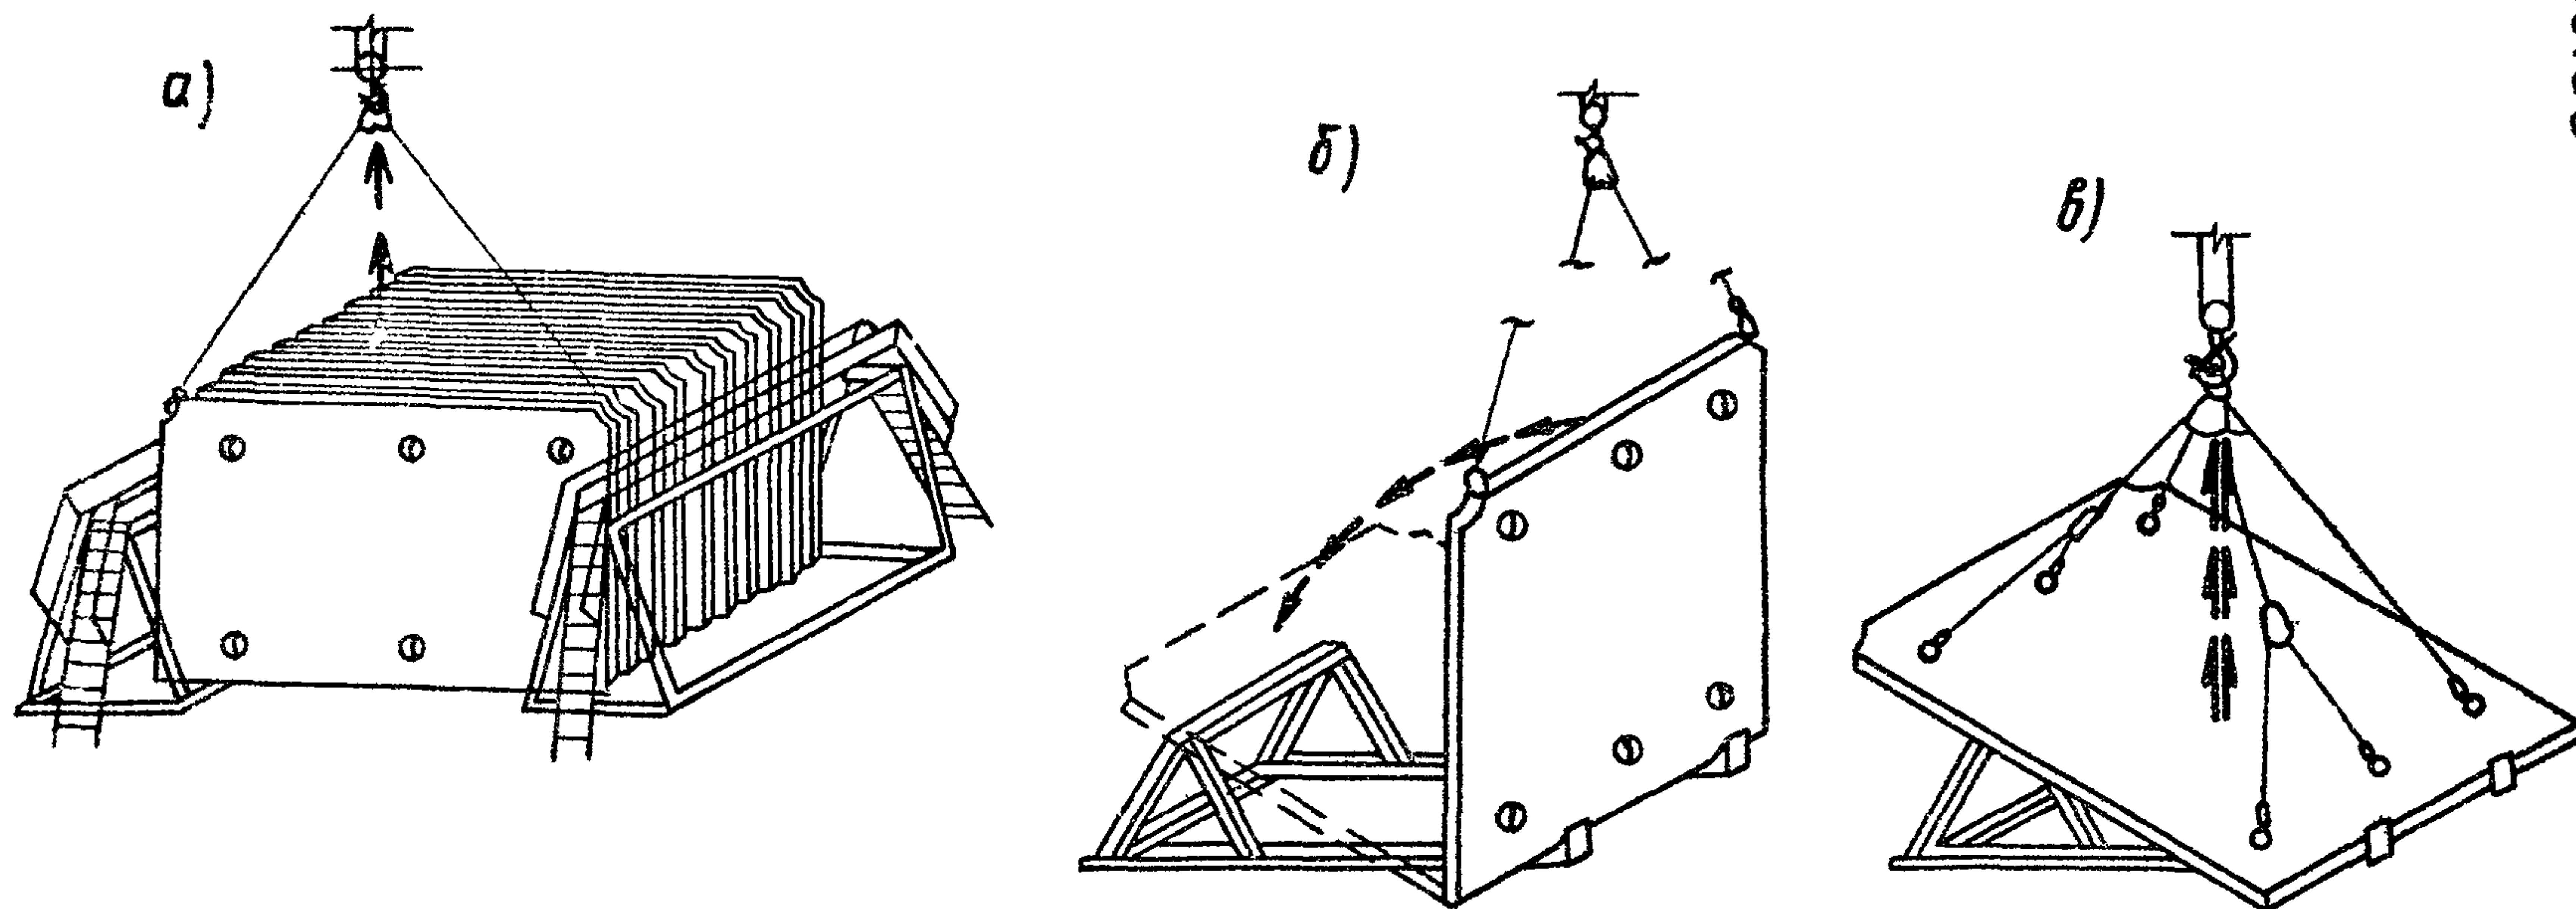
Последовательность перестропки панелей перекрытия: а-подъем панели перекрытия из кассеты; б-контование панели перекрытия; в-перестроповка
